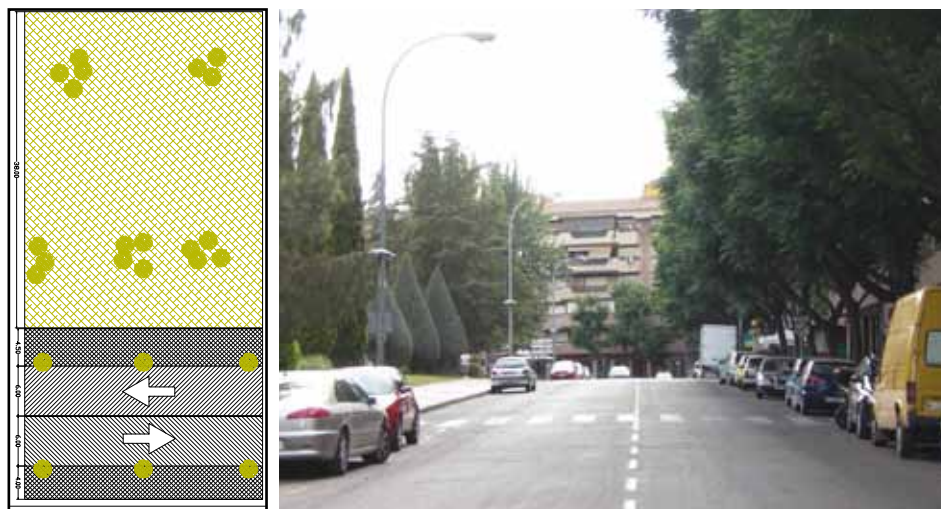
Tipo 7. Peatonal con vegetación. Calle Ramón y Cajal
